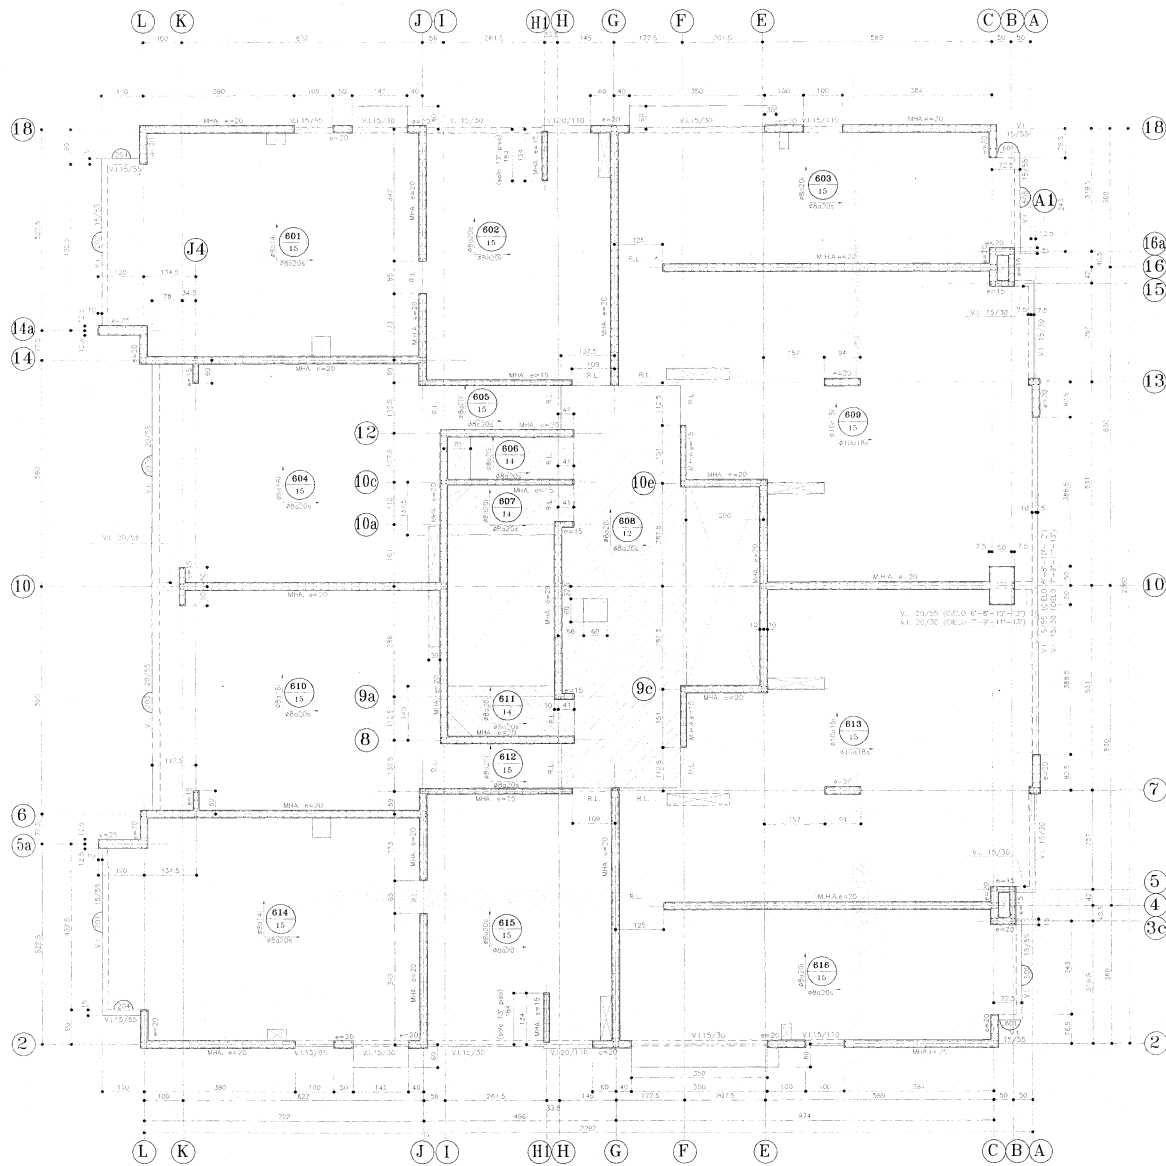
Plano estructural típico con vista en planta de Alto Arauco.
